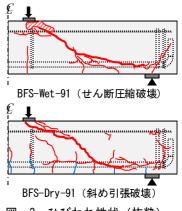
ひびわれ性状(抜粋) (赤線:載荷時に発生、青線:載荷前に発生 斜線:コンクリートの圧壊部)
